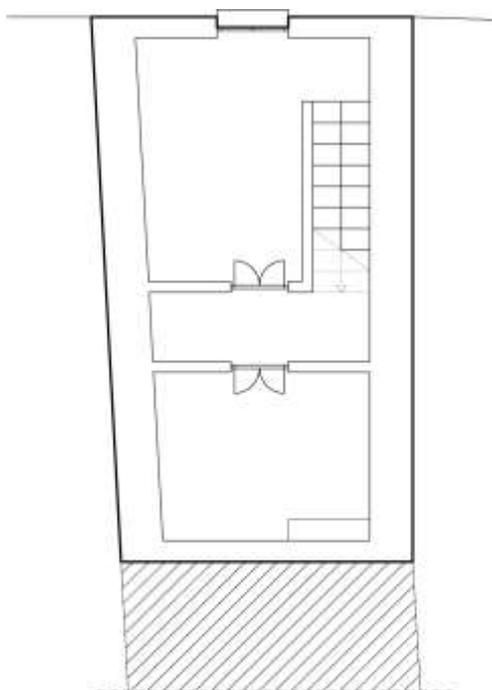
Planta do Piso 0 de uma casa torrejana (casa TN). (Ilustração nossa, 2021)
